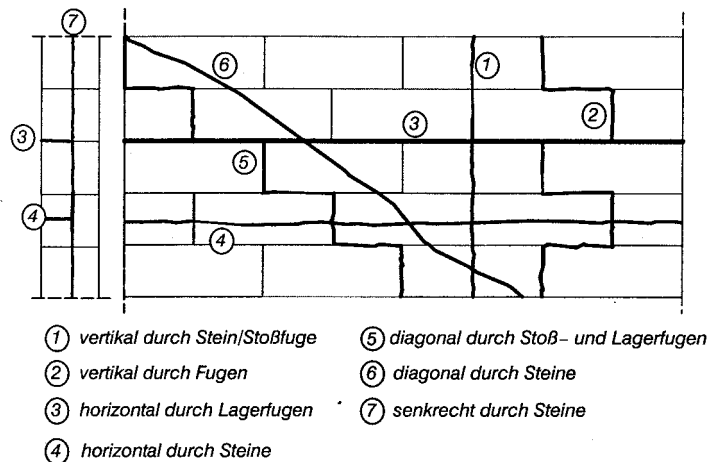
typisch Rissarten im Mauerwerk (aus [1])
